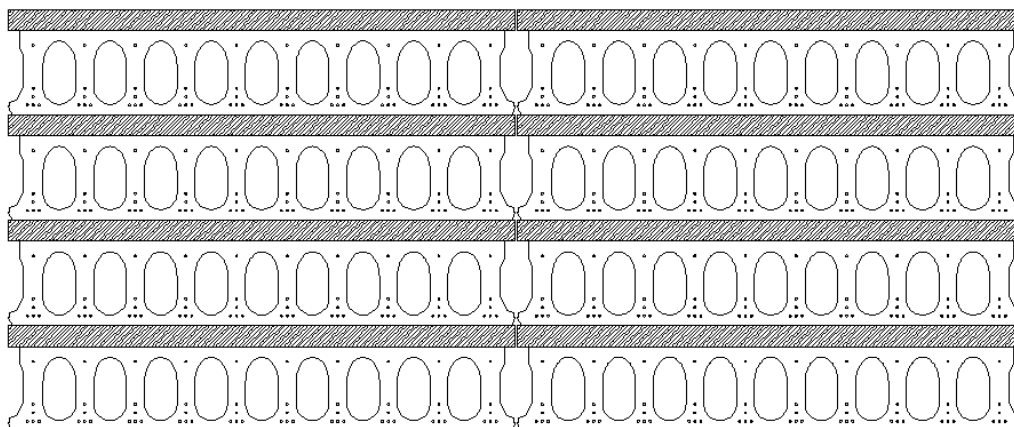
Colocação justaposta dos painéis com barrotos de madeira.
